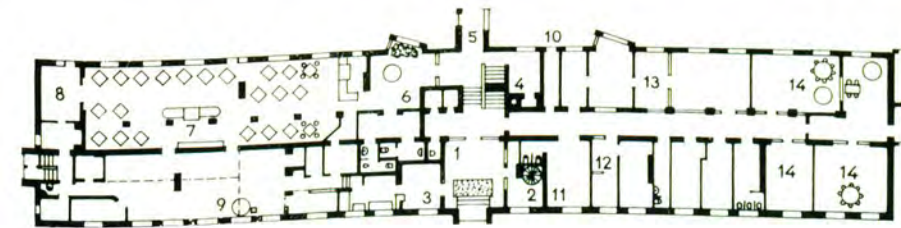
Kollektivhaus „Marieberg“ in Stockholm. Architekt: S. Lind, 1944
